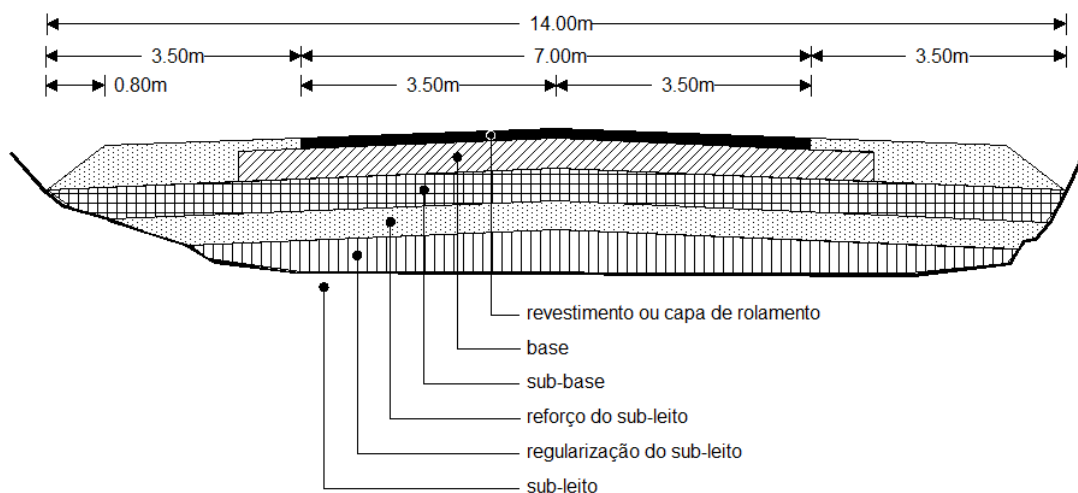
Esquema das camadas de um pavimento. Fonte: Faleiros, 2005, p. 4.
